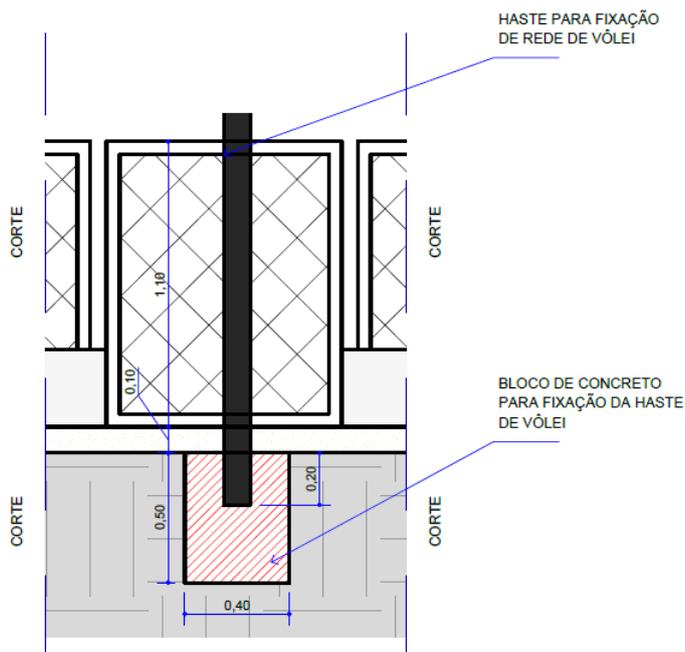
DETALHE DE HASTE FIXADA EM BLOCO DE CONCRETO – PROJETO DE ARQUITETURA
